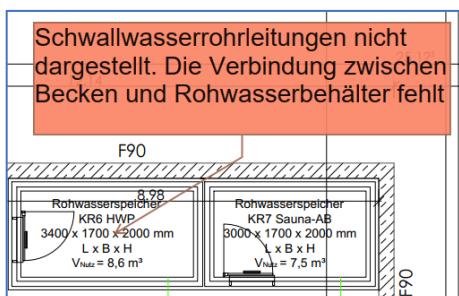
2.4.33 2021-10-22 905 472 Wassertechnik Grundriss E-2 Aufstellplan
